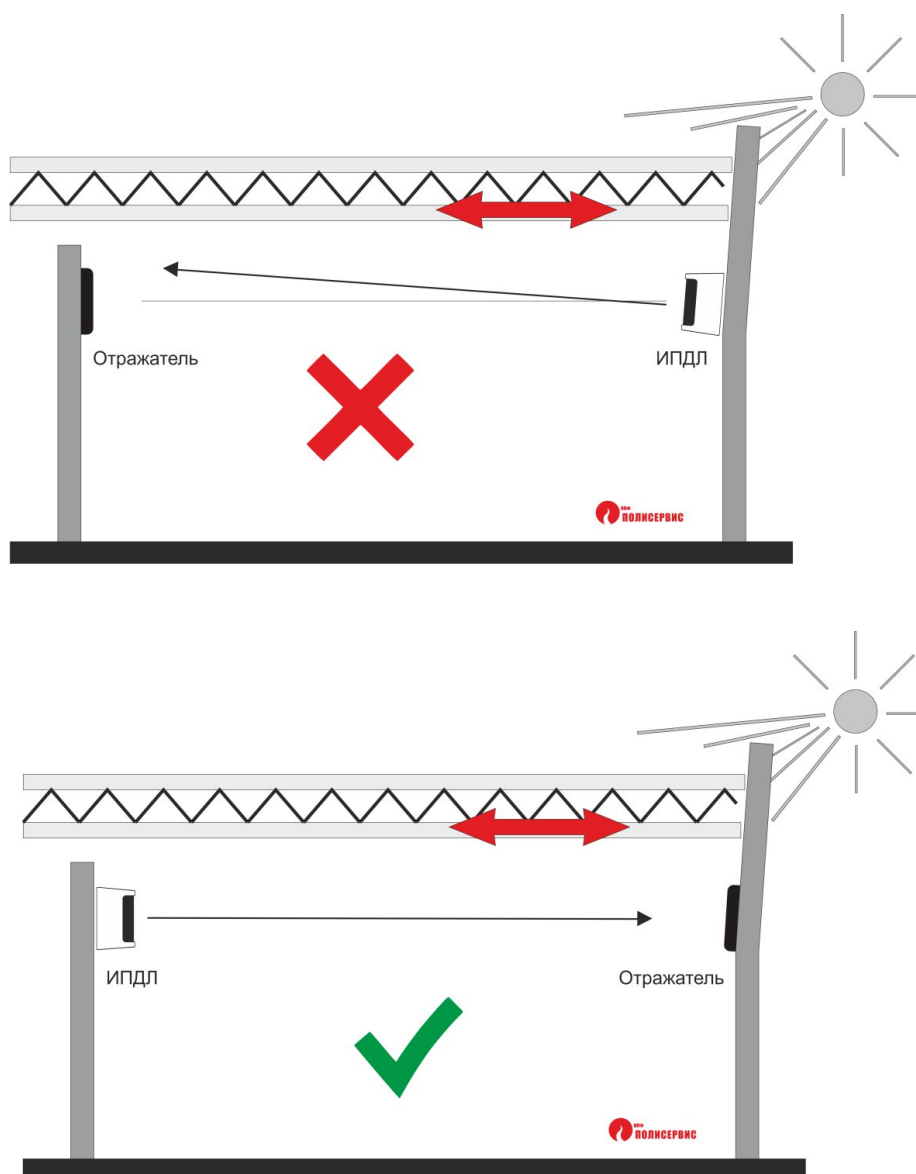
Установка ИПДЛ на стены, не соединенные с капитальной конструкцией.
